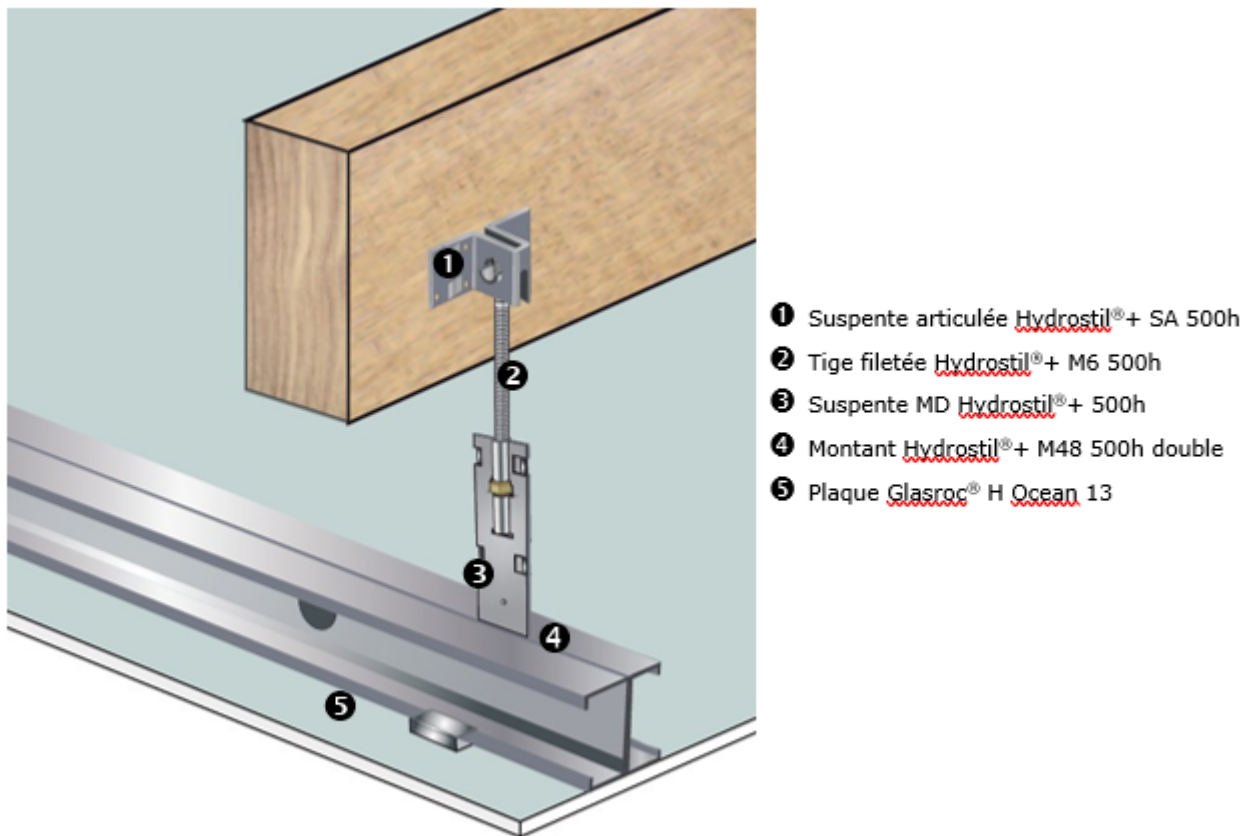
Plafond sur montants - Dispositif de suspension sous charpente bois
